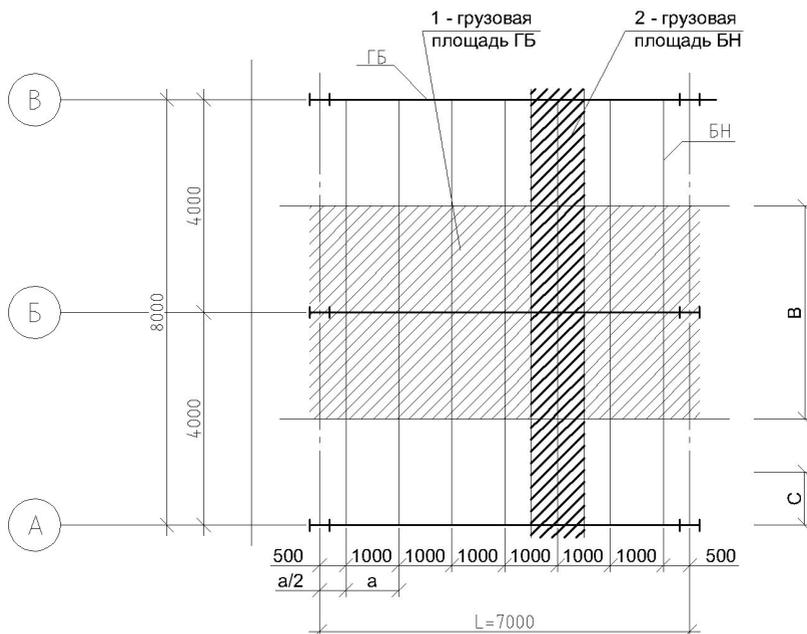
Грузовая площадь для главной балки ГБ (1); грузовая площадь для балки настила БН (2); а – шаг балок настила; С – 1 погонный метр длины балки настила
